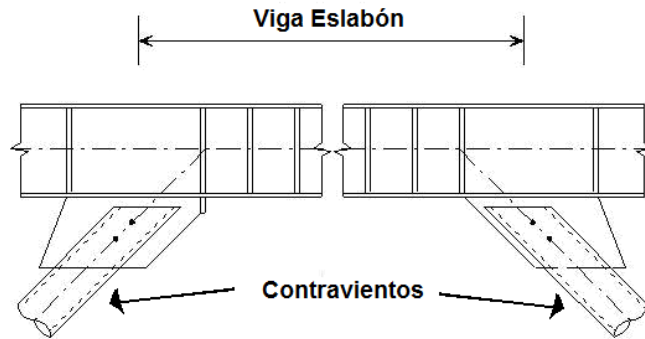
Segmento llamado Viga Eslabón (VE).
